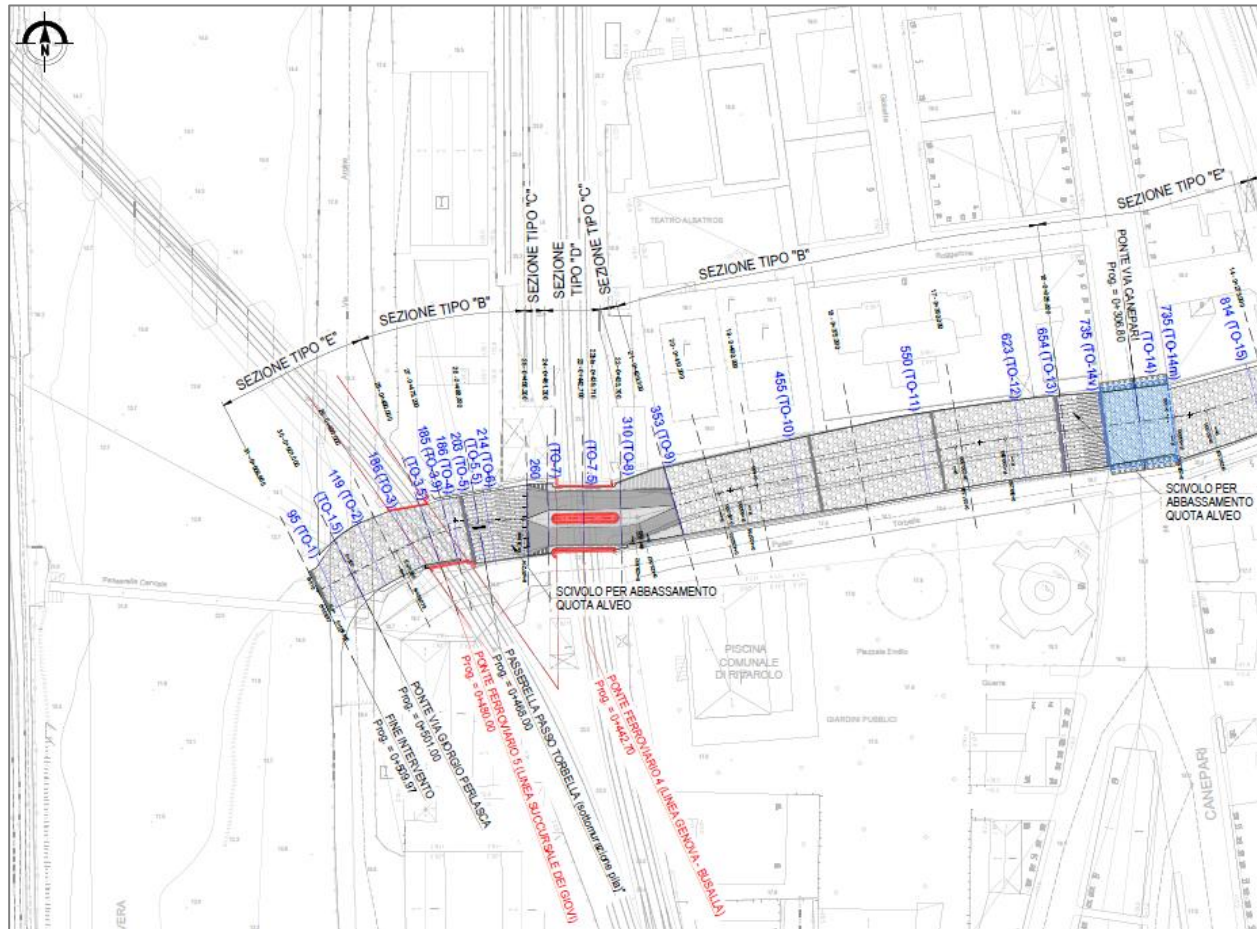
Planimetria dell'intervento con la rappresentazione delle sezioni per la modellazione idraulica (tratto di valle, II151F-PD-IDR-D002_0)
